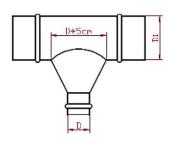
مسقط لشبكة مجرى هواء دائري المقطع
